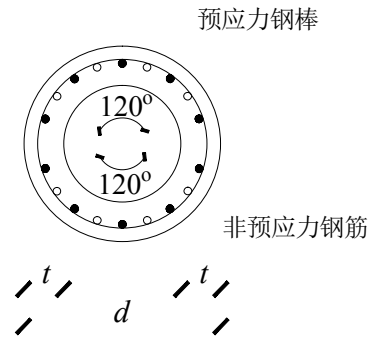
混合配筋混凝土管桩 (II 型)
